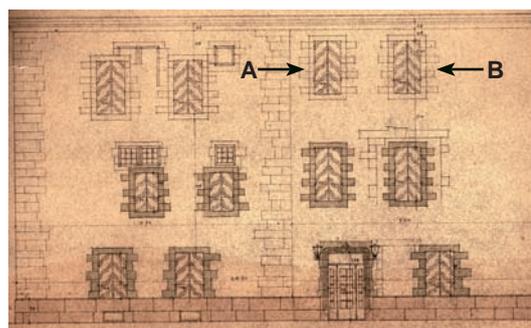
Façade ouest (ACPU, AA 2.1.0.3)
